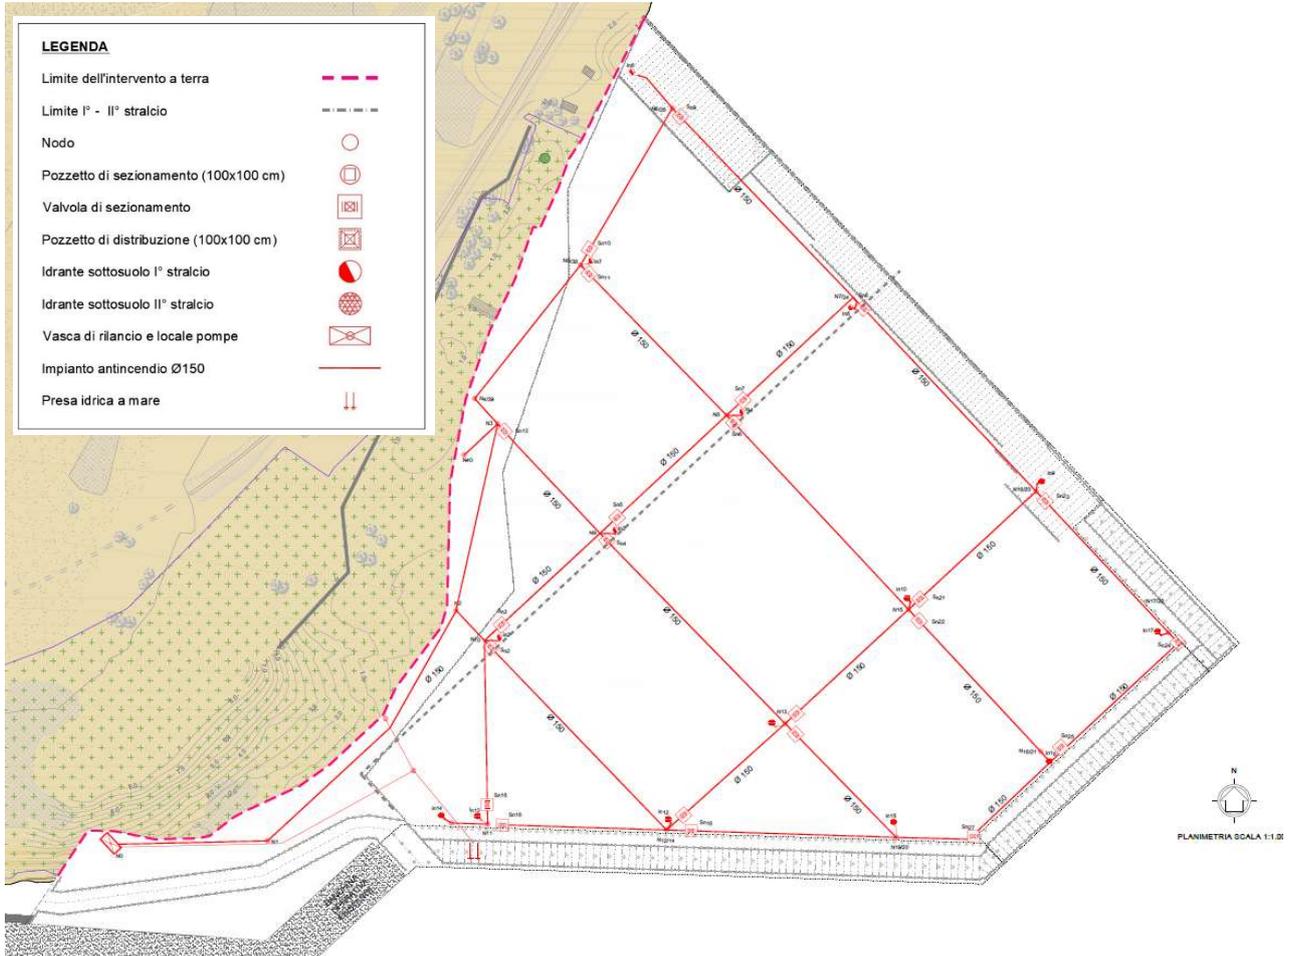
Planimetria rete antincendio Perizia di Variante
